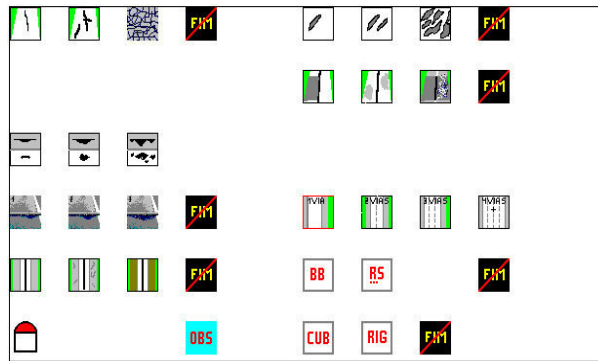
Teclado VIZIROAD da EP – Teclado para levantamento das degradações
